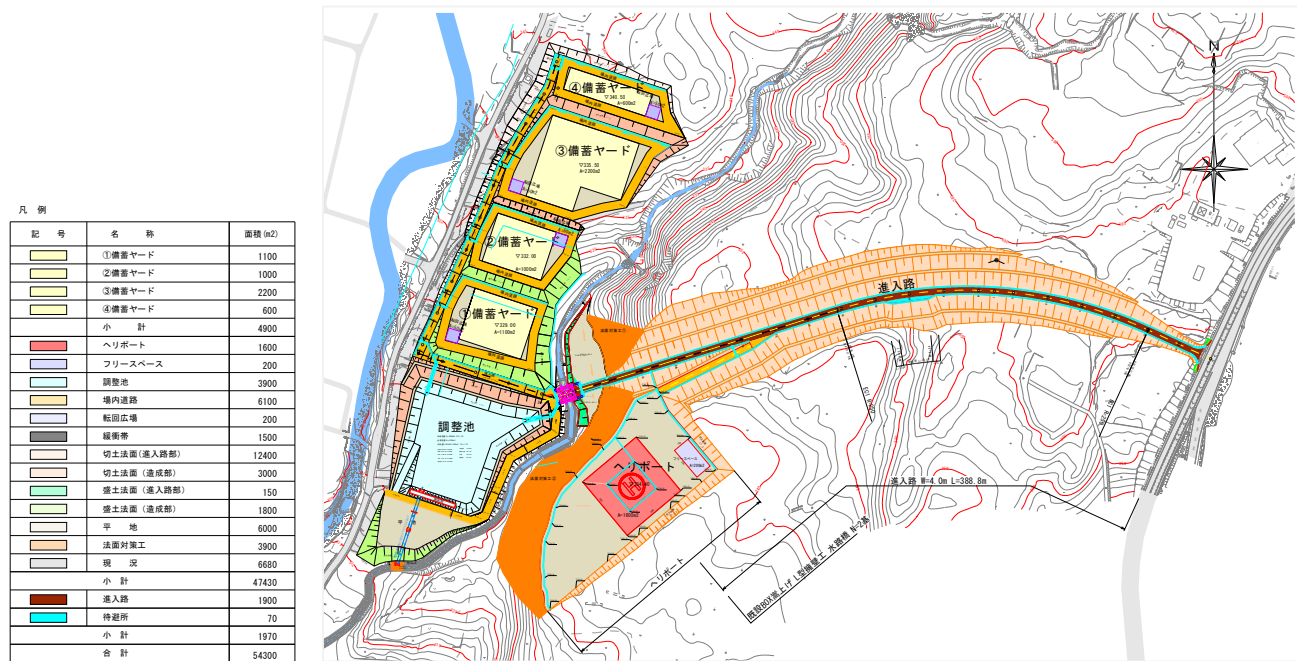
火山砂防防災施設（防災ステーション）の計画平面図
